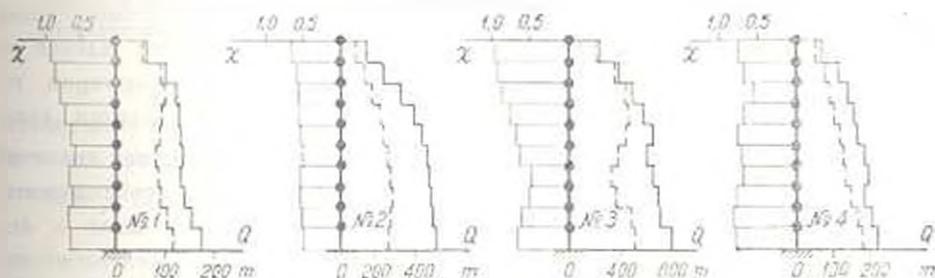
Эпюры перерезывающих сил для 10-этажного каркасного здания, вычисленные по акселерограммам №№ 1-4: — — — каркас из тяжелого железобетона; — — — каркас из легкого железобетона.
